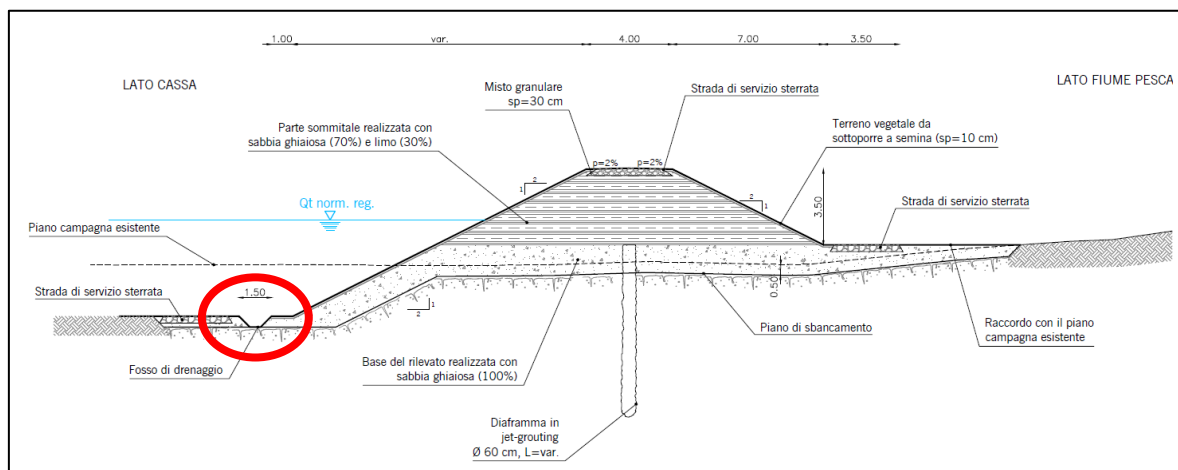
Sezione tipologica di rilevato arginale con indicazione del fosso di drenaggio.
